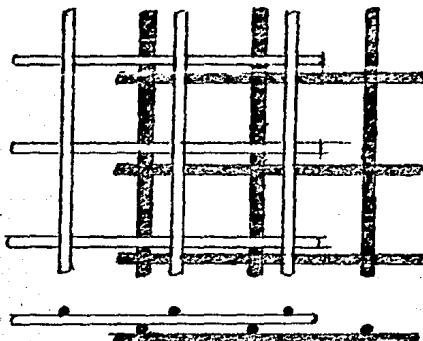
Traslape engomas en que el acero trabaja más de la mitad del esfuerzo permisible. B esfuerzo estructural.
